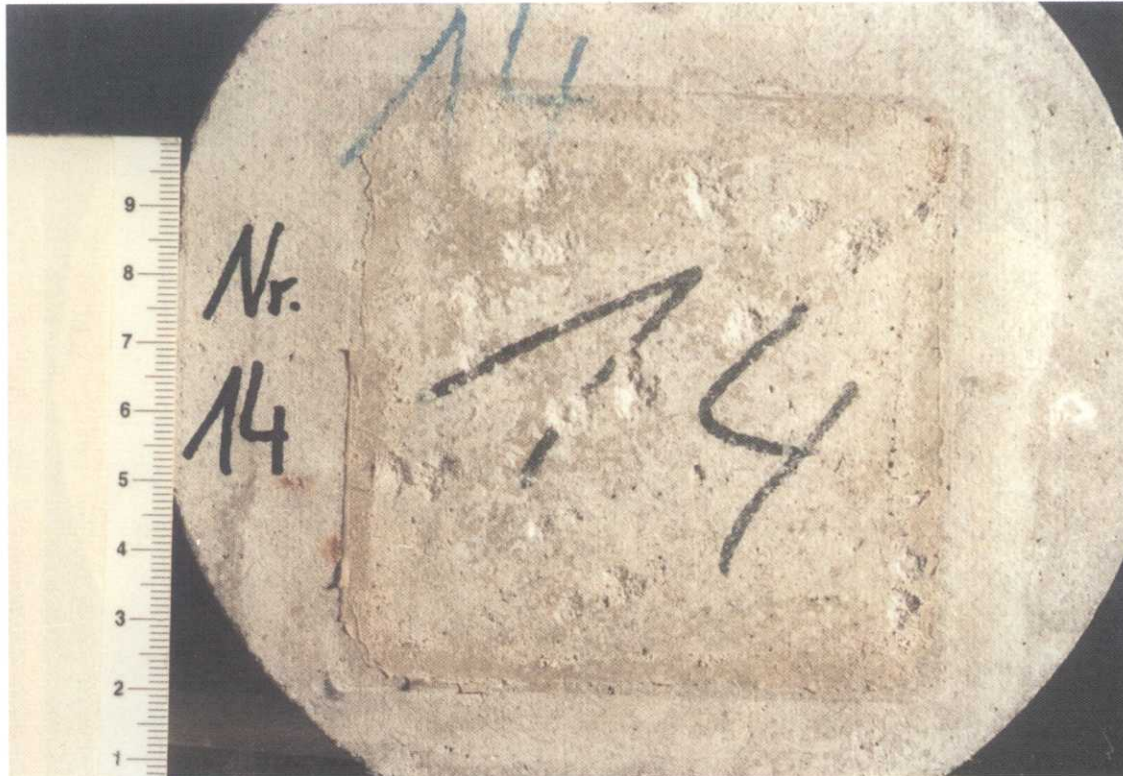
wie Foto 17, jedoch Betonoberfläche unter Verwendung der ZEMDRAIN-Schalungsbahn hergestellt.
